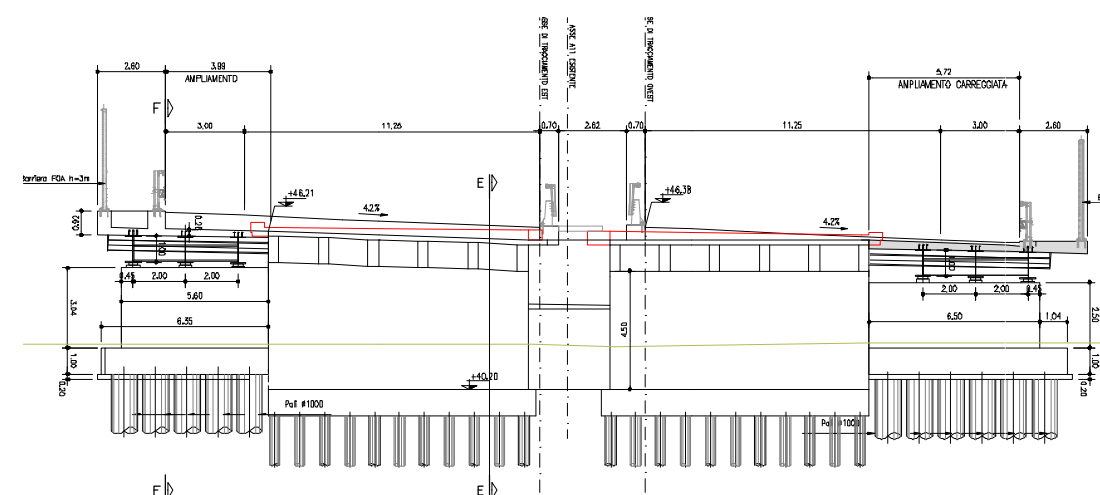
Viadotto sul F. Iolo. Sezione trasversale.
